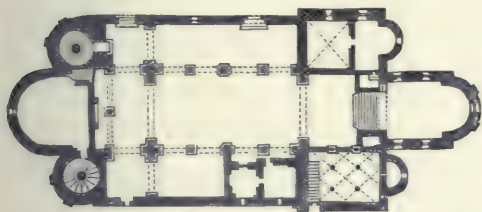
Die Stiftskirche zu Gernrode. Grundriss.
